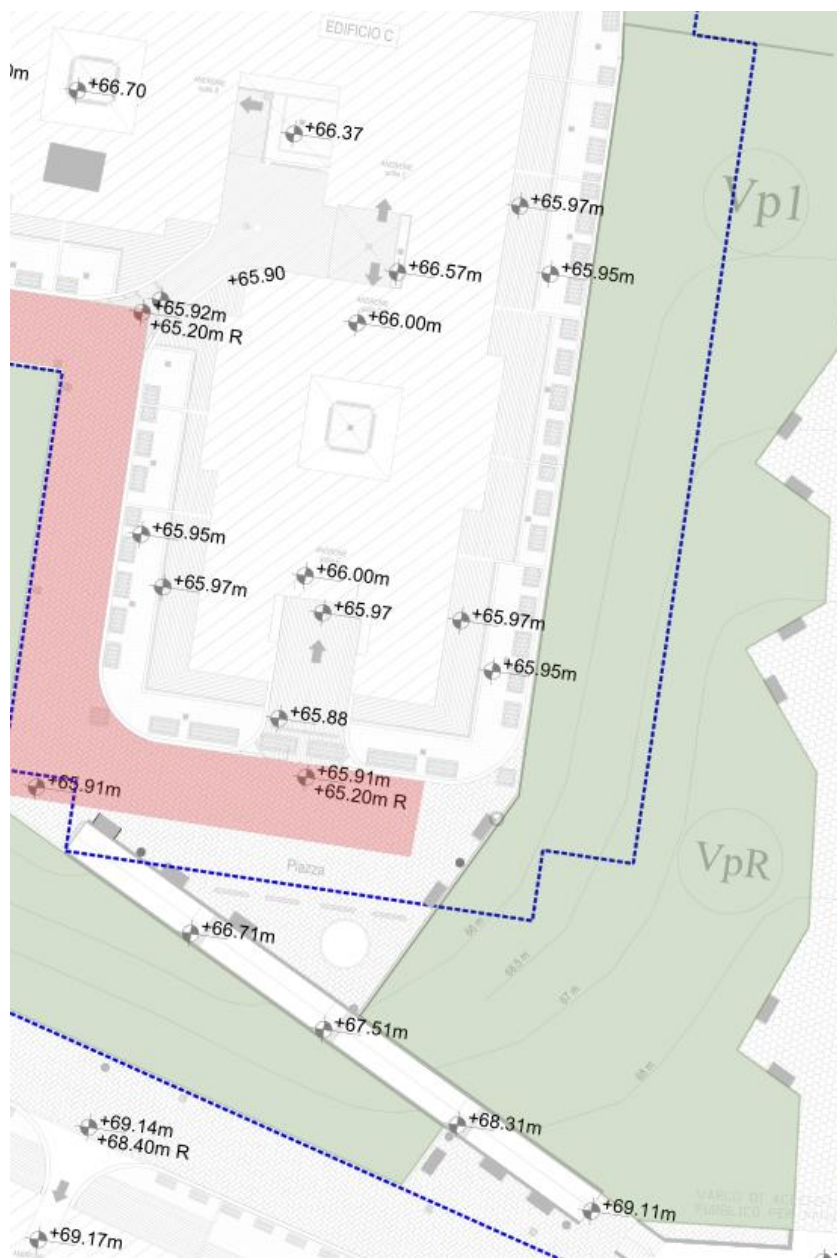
Zona con pavimentazione e opere di captazione acqua meteorica
